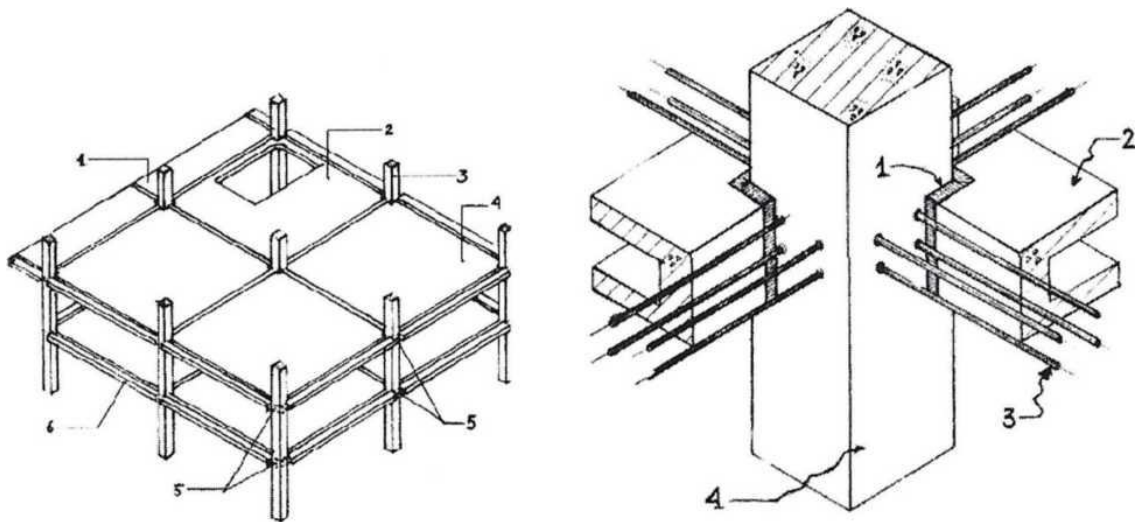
Несучий каркас ІМС з натягом робочої арматури в будівельних умовах для багатоповерхових цивільних будівель а - принципова конструкція каркасу; 1 - консольне переkritтя; 2 - переkritтя з отвором для сходів; 3 - колона; 4 - типове переkritтя; 5 - канатна арматура, що напружується; 6 - фасадна розпірка; б - конструкція вузла примикання плит переkritтя до колони; 1 - контактний шов; 2 - плита; 3 - канат К-7; 4 – колона
